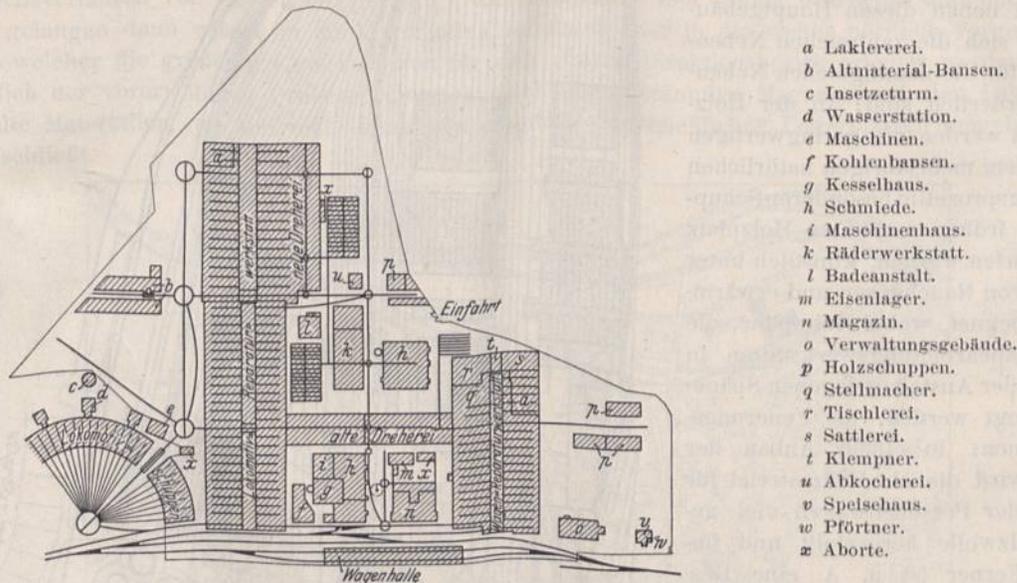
Lageplan der Hauptwerkstatt Breslau-Odertor. 1 : 5000.
